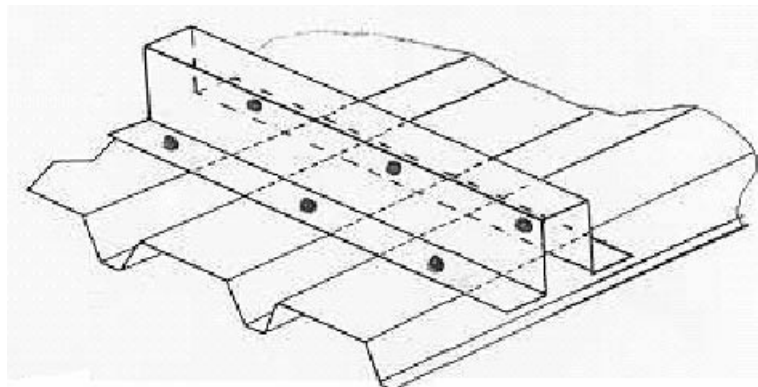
Fixation complète d'une fausse panne sur un profil HACIERO
